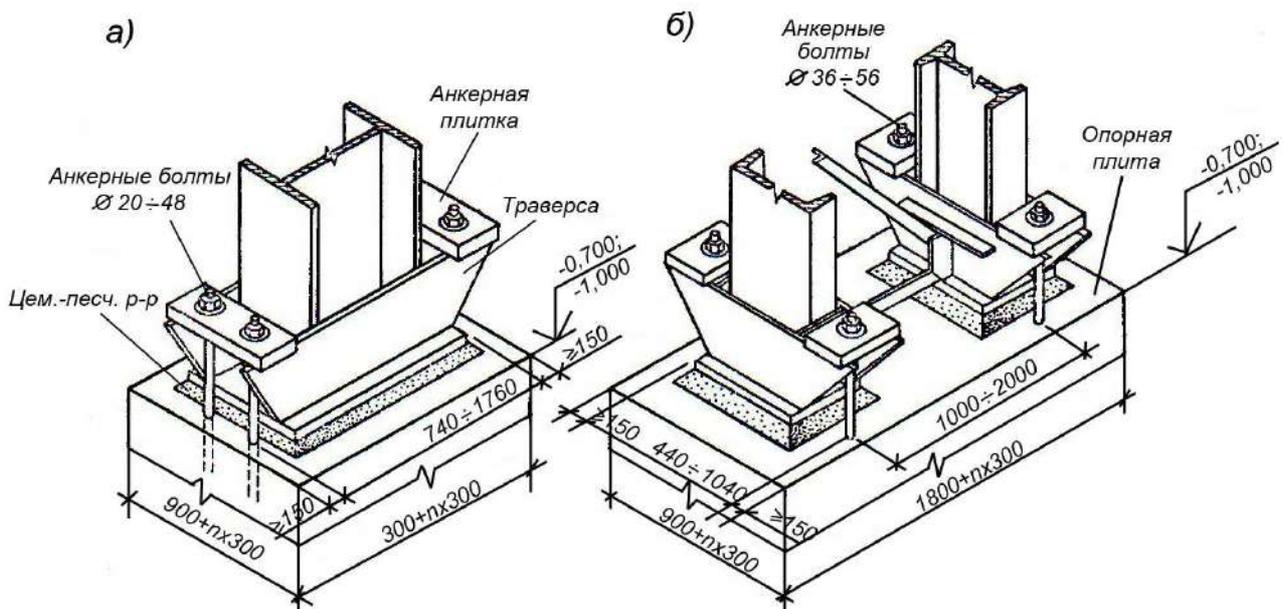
Монолитные железобетонные фундаменты под стальные колонны:
